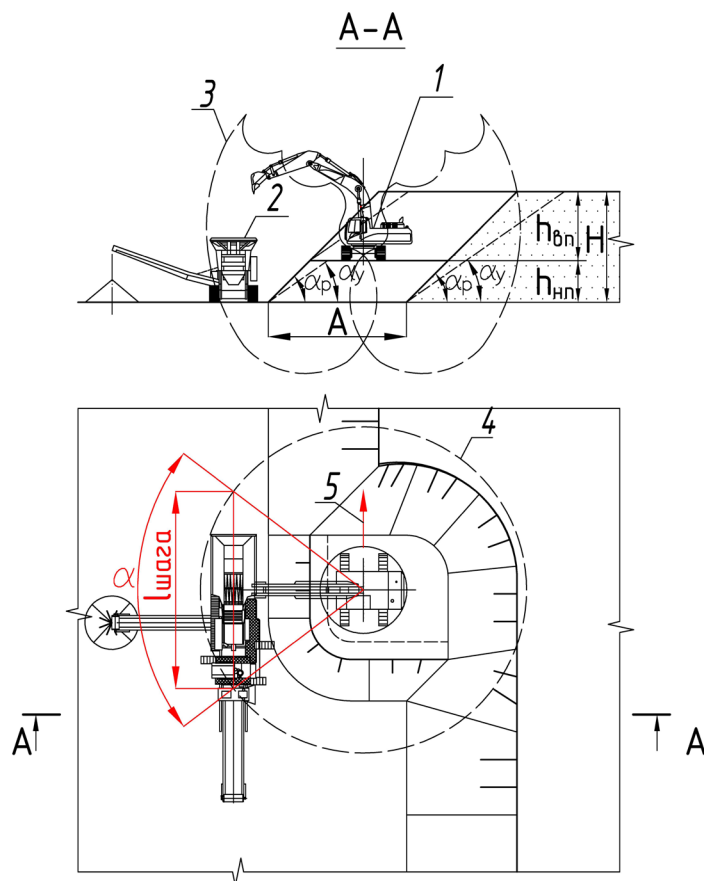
Технологическая схема ведения добычных работ с погрузкой в мобильный агрегат дробления/грохочения: 1 – экскаватор; 2 – МДА; 3 – кинематическая схема движения ковша экскаватора; 4 – зона влияния ковша экскаватора; 5 – направление движения добычного забоя; А – ширина заходки экскаватора; $h_{вп}$ – высота верхнего подступа; $h_{нп}$ – высота нижнего подступа; Н – общая высота уступа; α_p – рабочий угол откоса уступа; α_y – устойчивый угол откоса уступа; α – изменение угла поворота стрелы в пределах одной передвигки МДА; $l_{шага}$ – расстояние однократной передвигки МДА.
